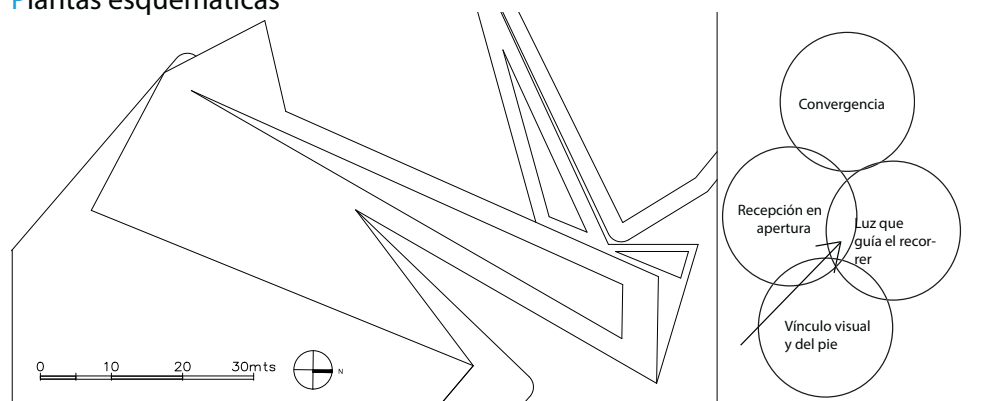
Planta techumbre proyecto. Fuente elaboración grupal
